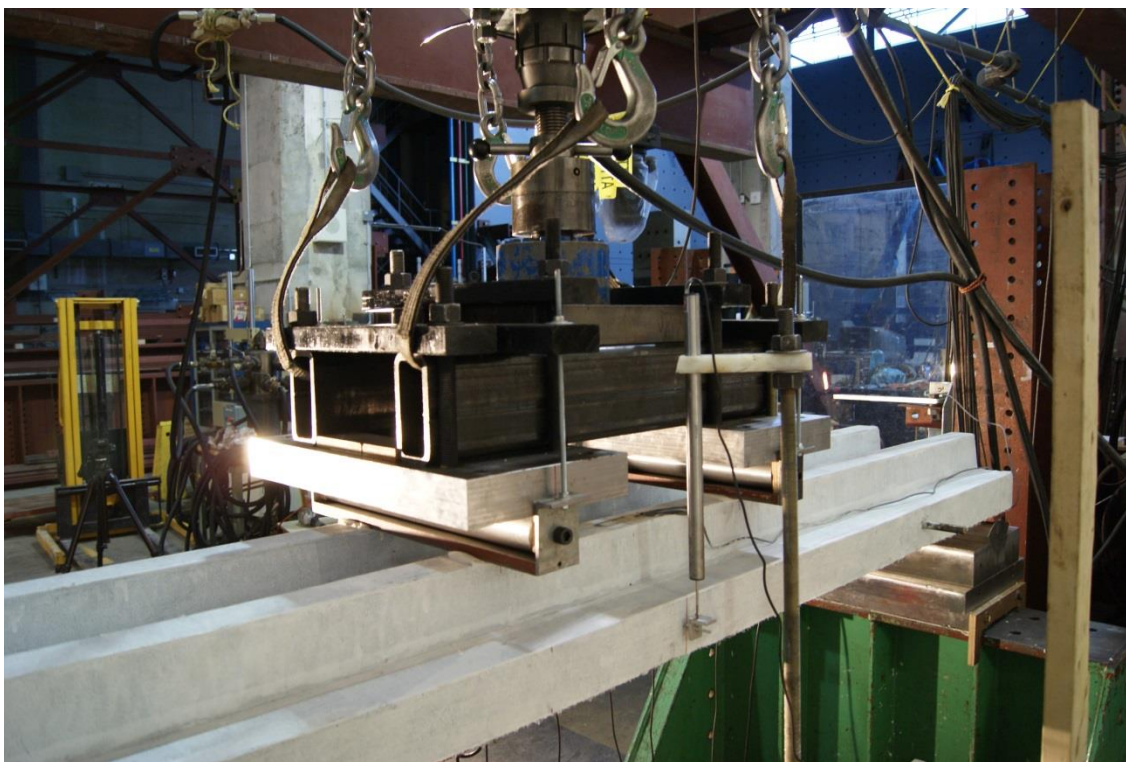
Poutre de transfert installée sur la dalle nervurée en BFUP (moment négatif)
